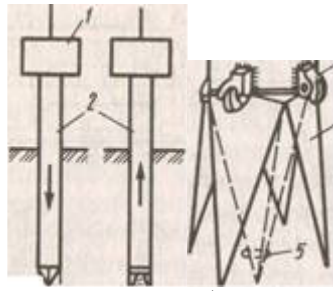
Схема устройства на песчаных (грунтовых) набивных свай
